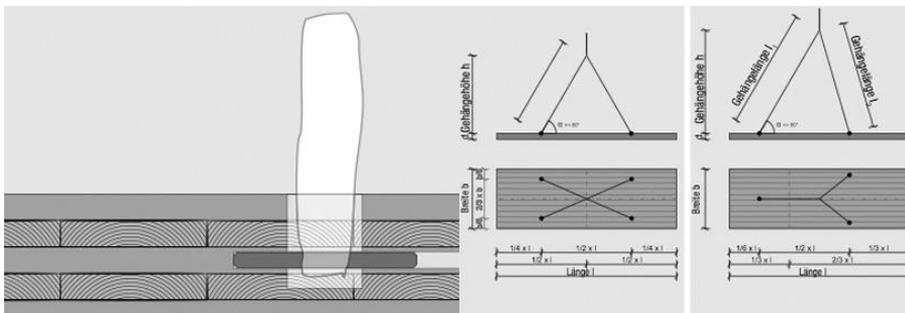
Deckenhebesystem (verdeckt) Stabdübel Schlaufe und Transportgehänge mit 4- und 3-Punktlagerung¹⁷⁰
